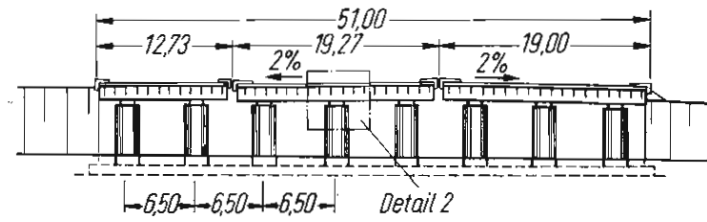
Alzados del puente de autopistas en Gambach.
